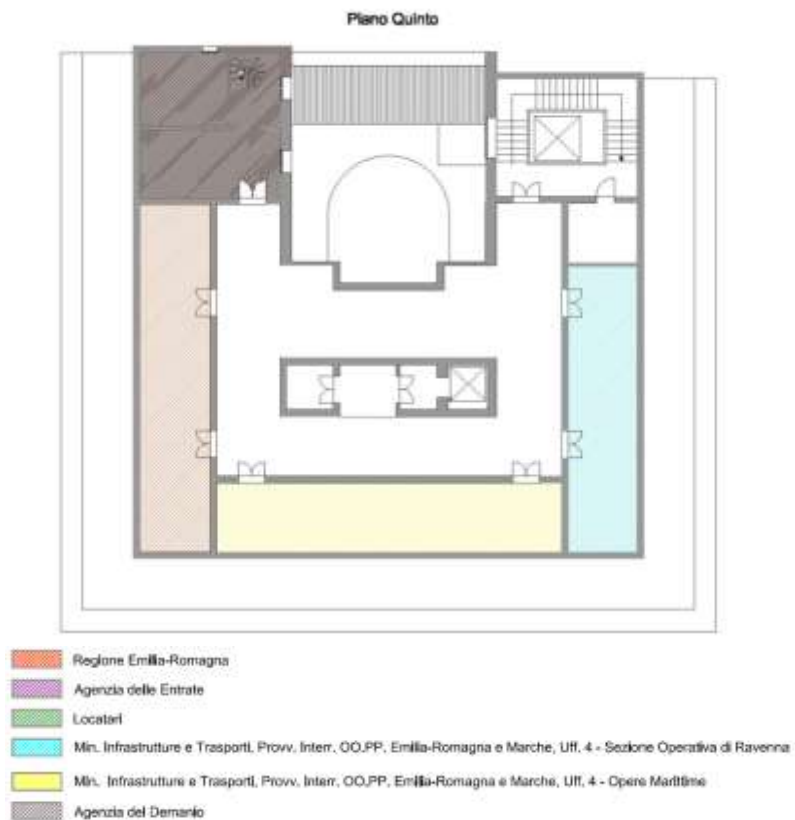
Pianta degli spazi occupati: piano quinto.
